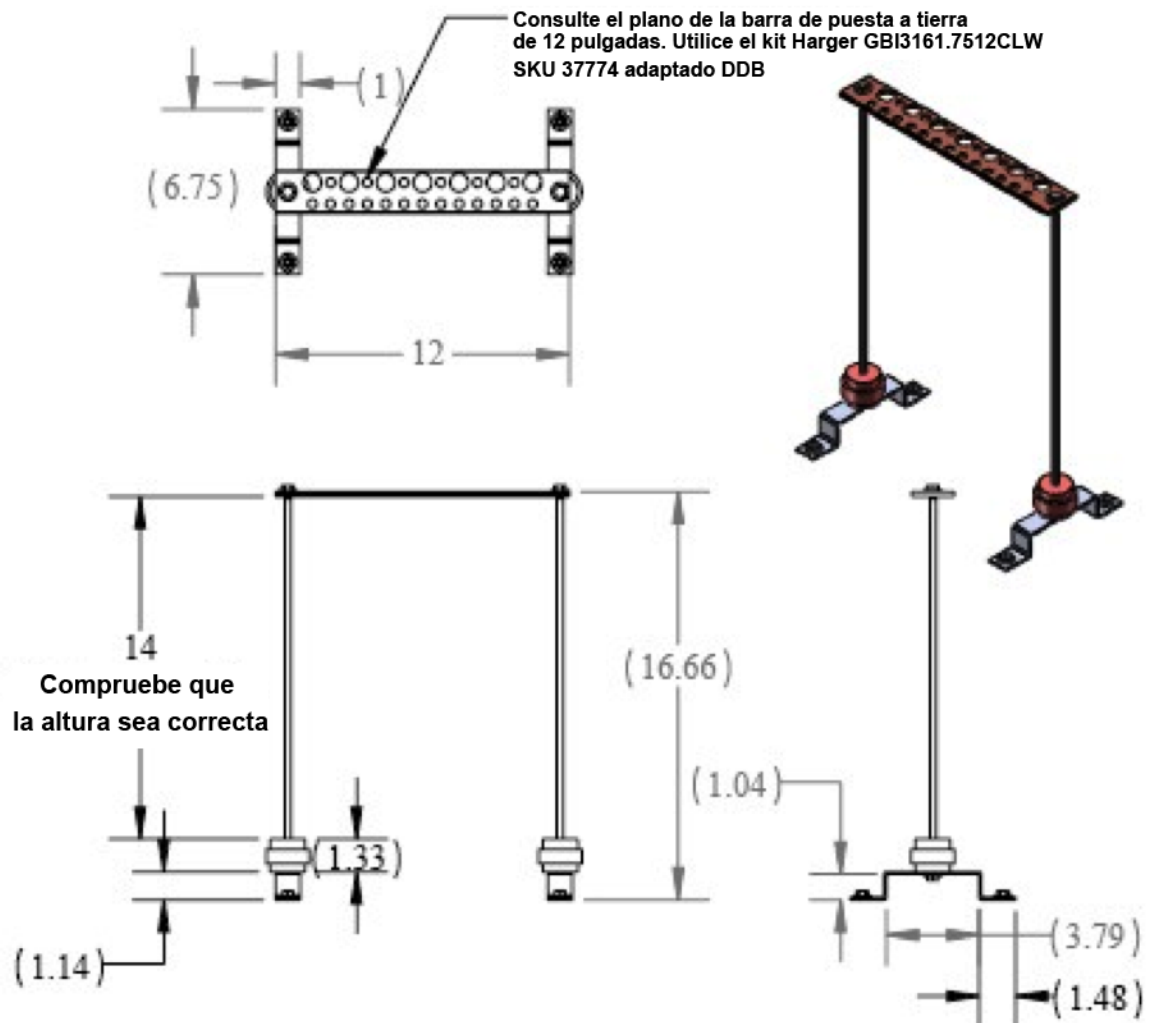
DETALLE DEL CONJUNTO DE LA BARRA DE PUESTA A TIERRA
